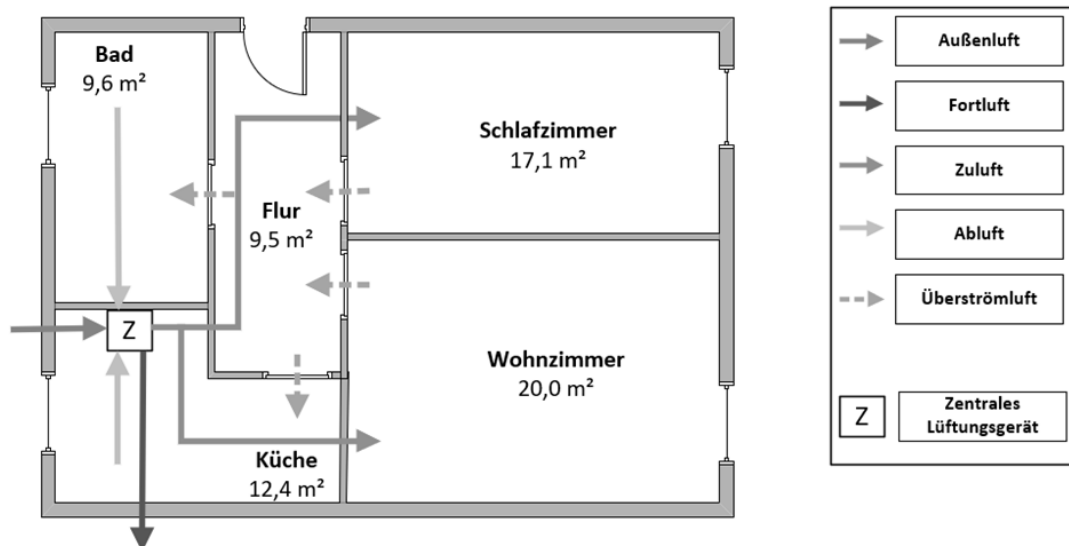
Grundriss Zwei-Zimmer-Wohnung, Schematische Darstellung zentrales Lüftungssystem
